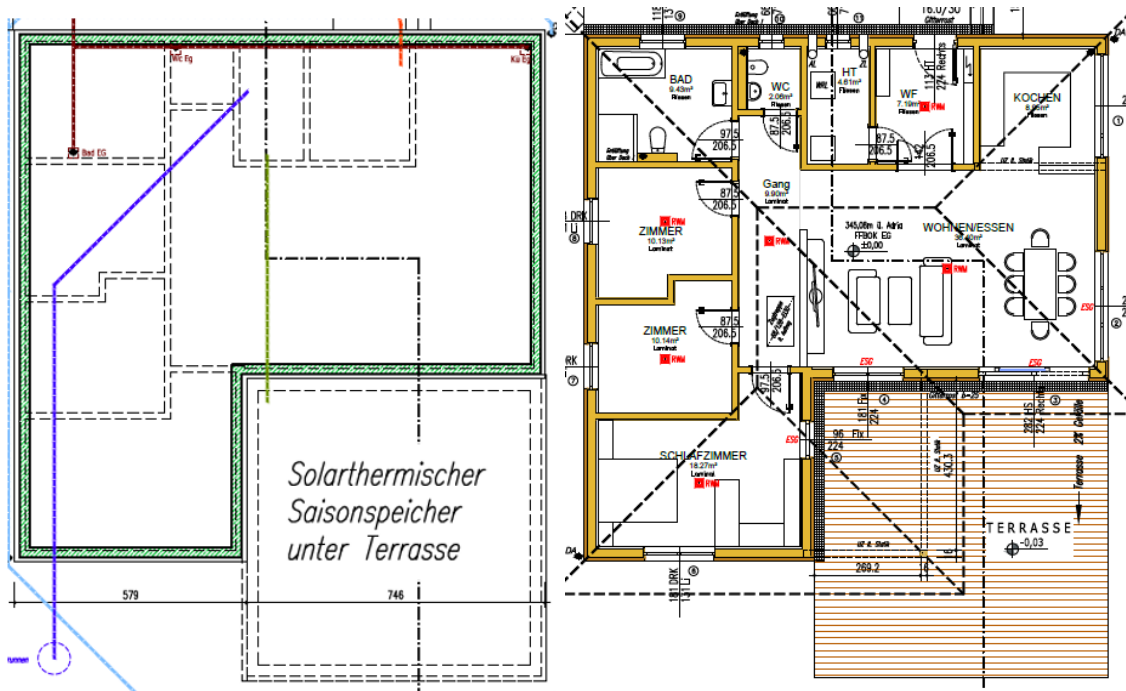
Grundriss von Keller inkl. Position Saisonspeicher (links) und Erdgeschoss (rechts) (Quelle: Einreichplan)
